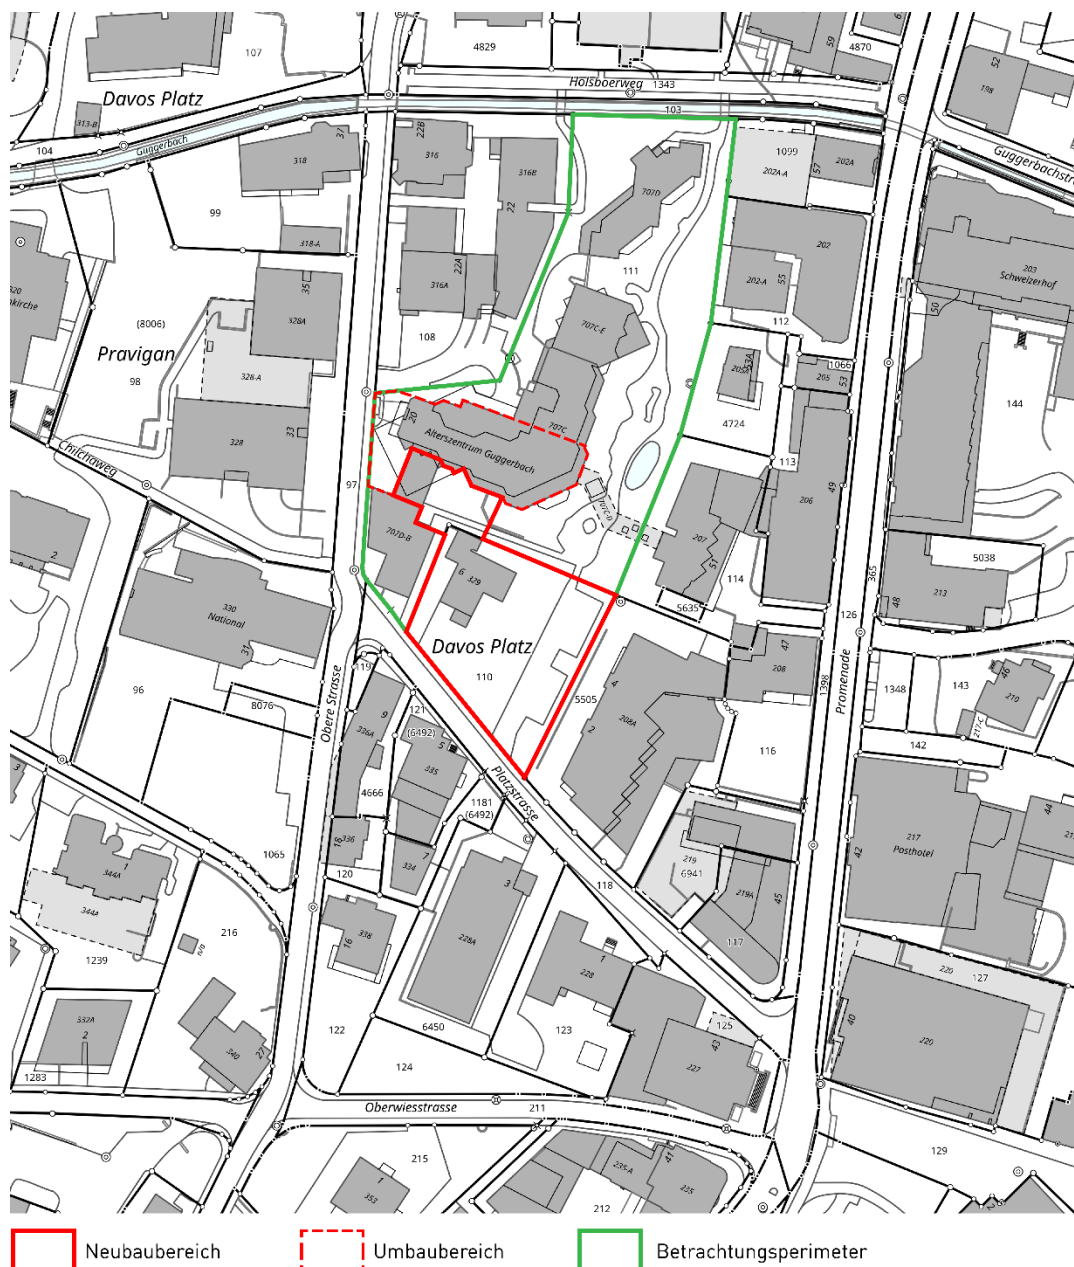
Wettbewerbs- und Betrachtungsperimeter
